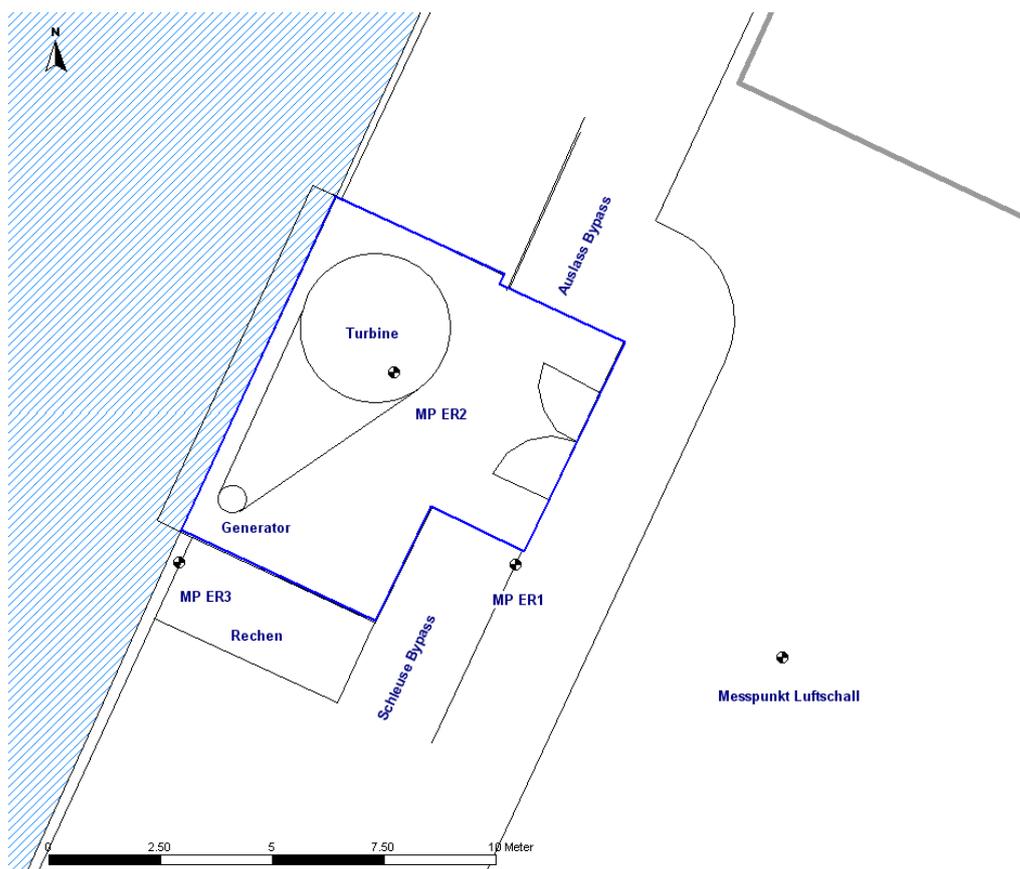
Lageplan mit Messpunkten am 15.5.2012, Anlage skizziert
